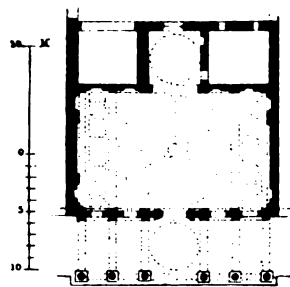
Capp. Pazzi zu Florenz. Grundriss. (Nach Paulus.)
